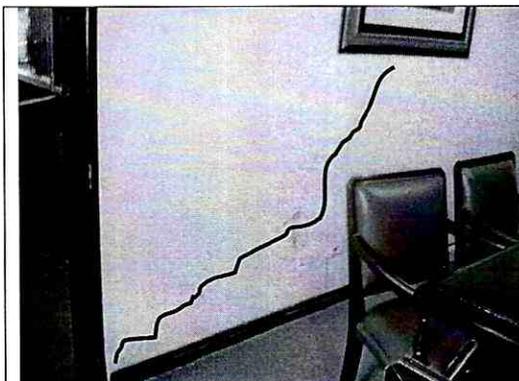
Grietas en muros de primer piso del edificio de oficinas, "CENTRO EJECUTIVO CHICO",
